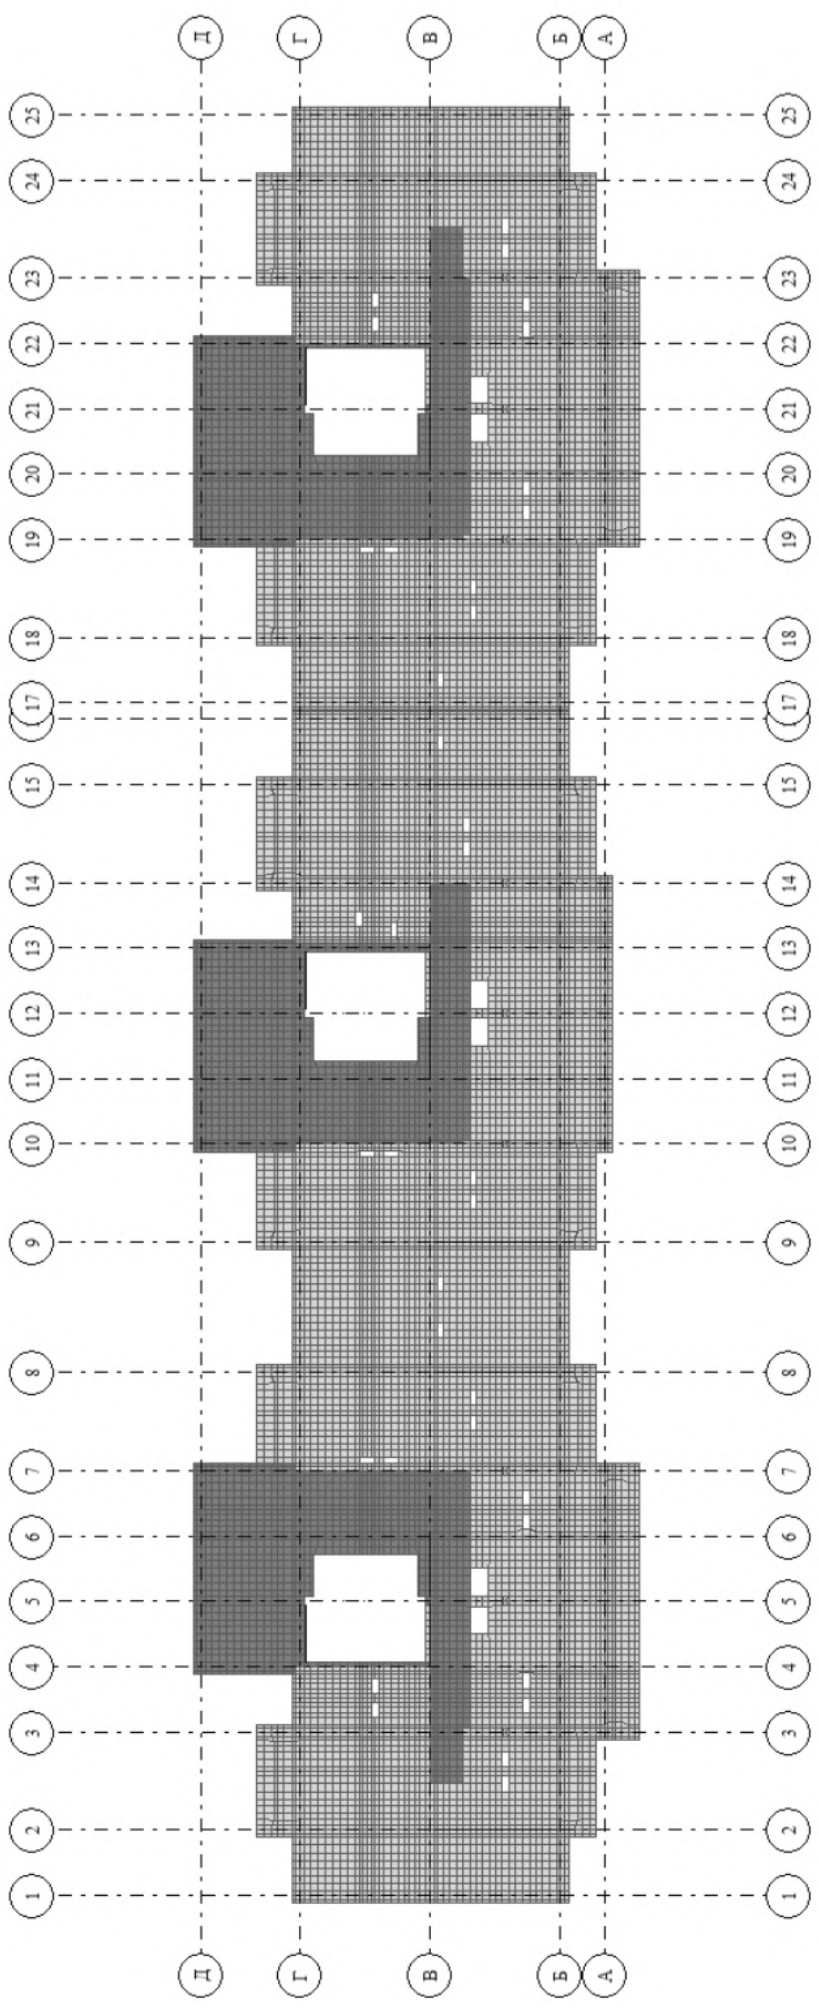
Мозаика полезной нагрузки на перекрытие типового этажа (загружение 8)
